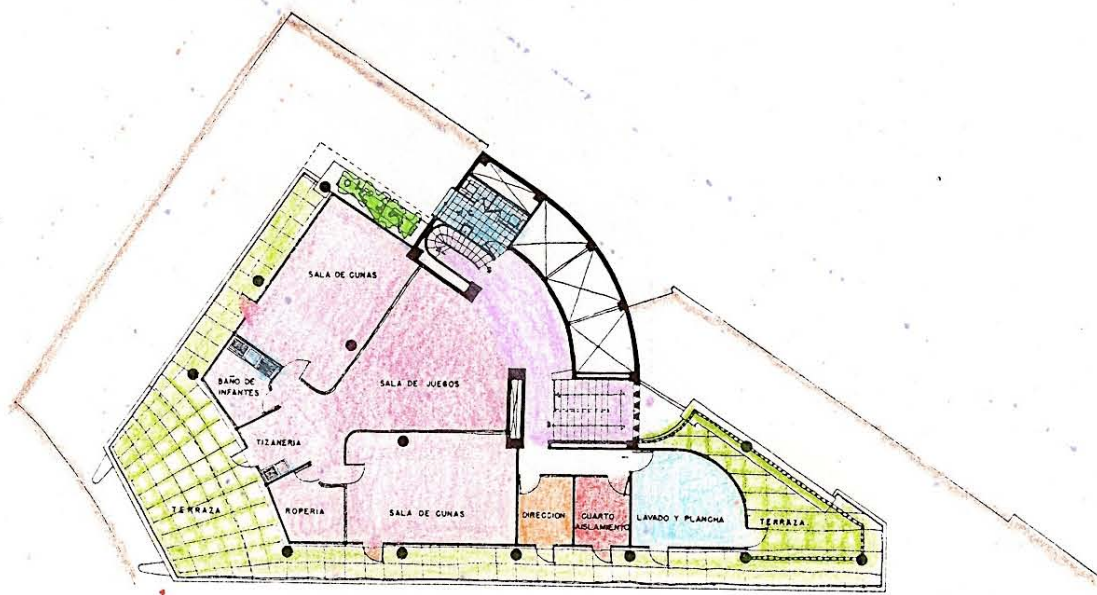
Plantas arquitectónicas 13º piso, Ministro y 19º piso guardería
